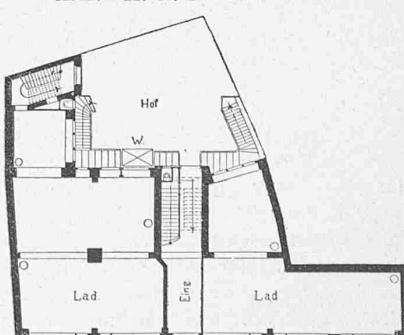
Grundriss vom Erdgeschoss 1:500.
